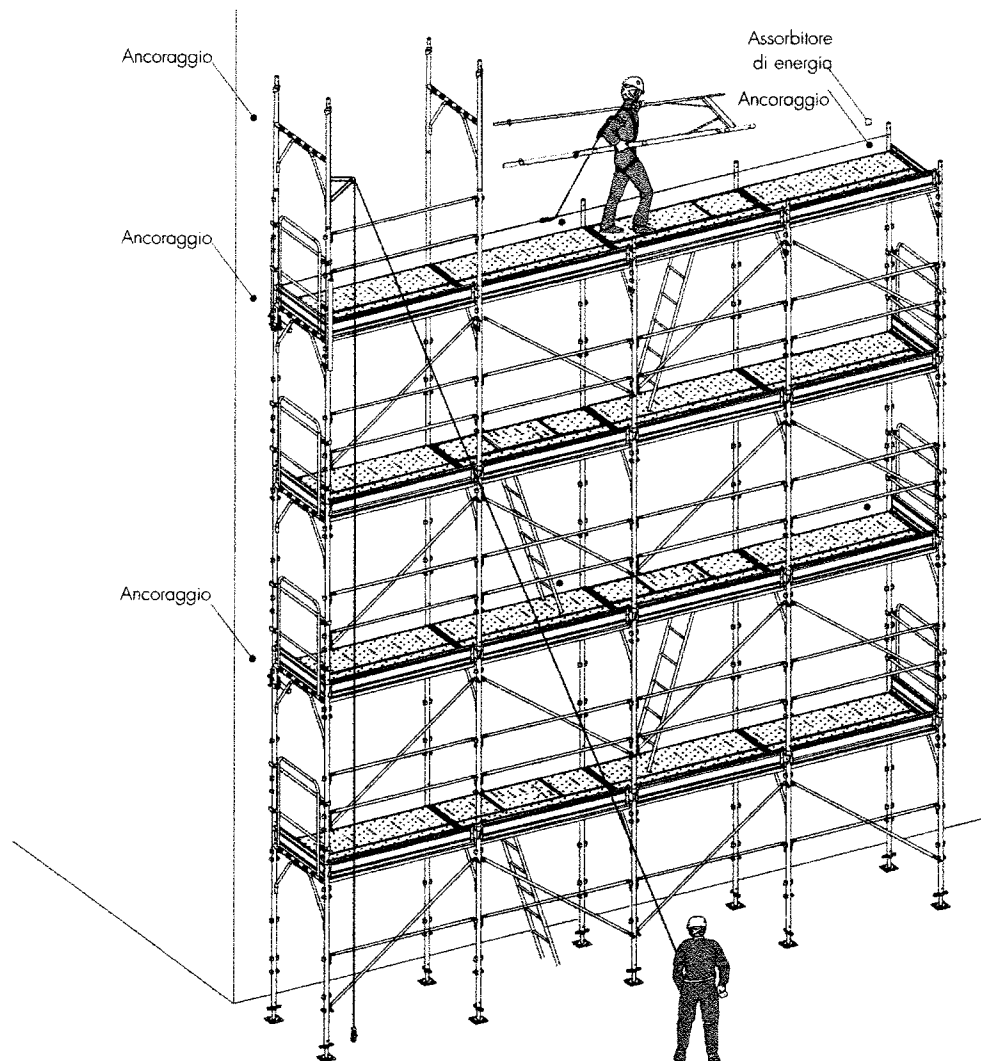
Esempio di montaggio con argano di sollevamento al piano di assemblaggio
